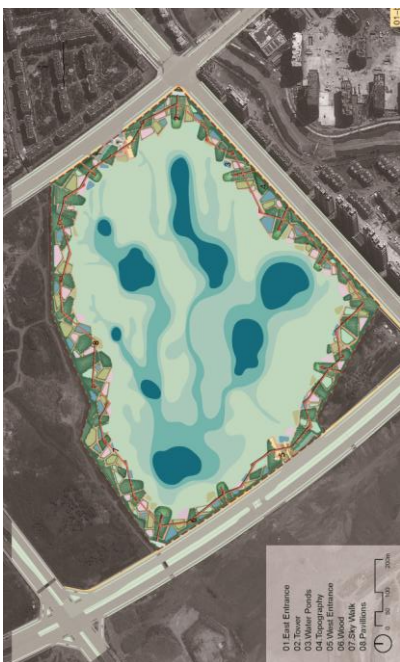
| Masterplan do Qunli Stormwater Wetland Park
